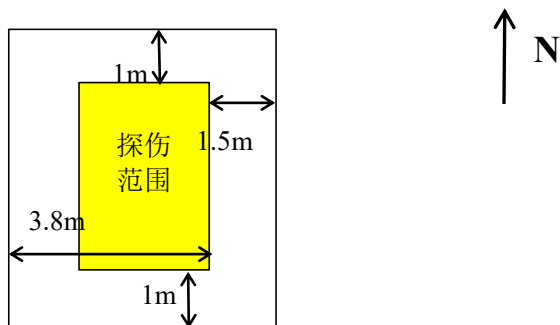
探伤机距探伤室各墙体距离示意平面图
